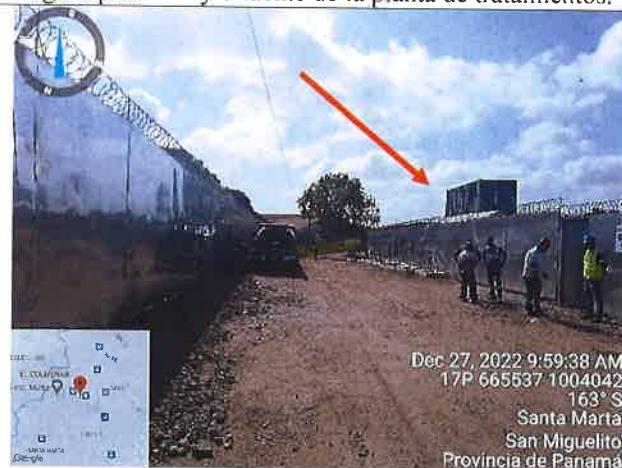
y 7. Vistas de las infraestructuras para las futuras edificaciones.
